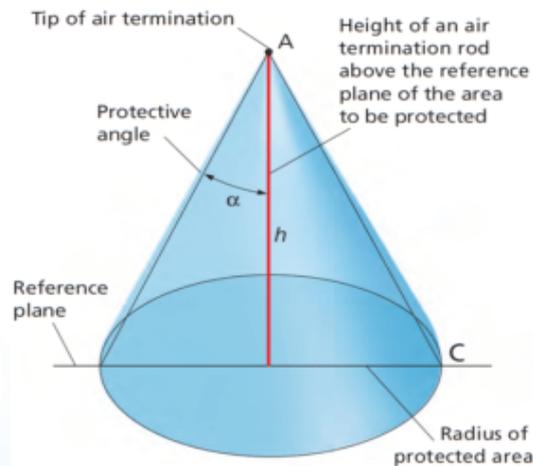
Esquema de determinación de protección en el Método del ángulo de protección, donde: – Plano de referencia, – Ángulo de protección, – Punta de terminación de aire, – Altura de una barra de terminación de aire sobre el plano de referencia del área a proteger, – Radio del área protegida
